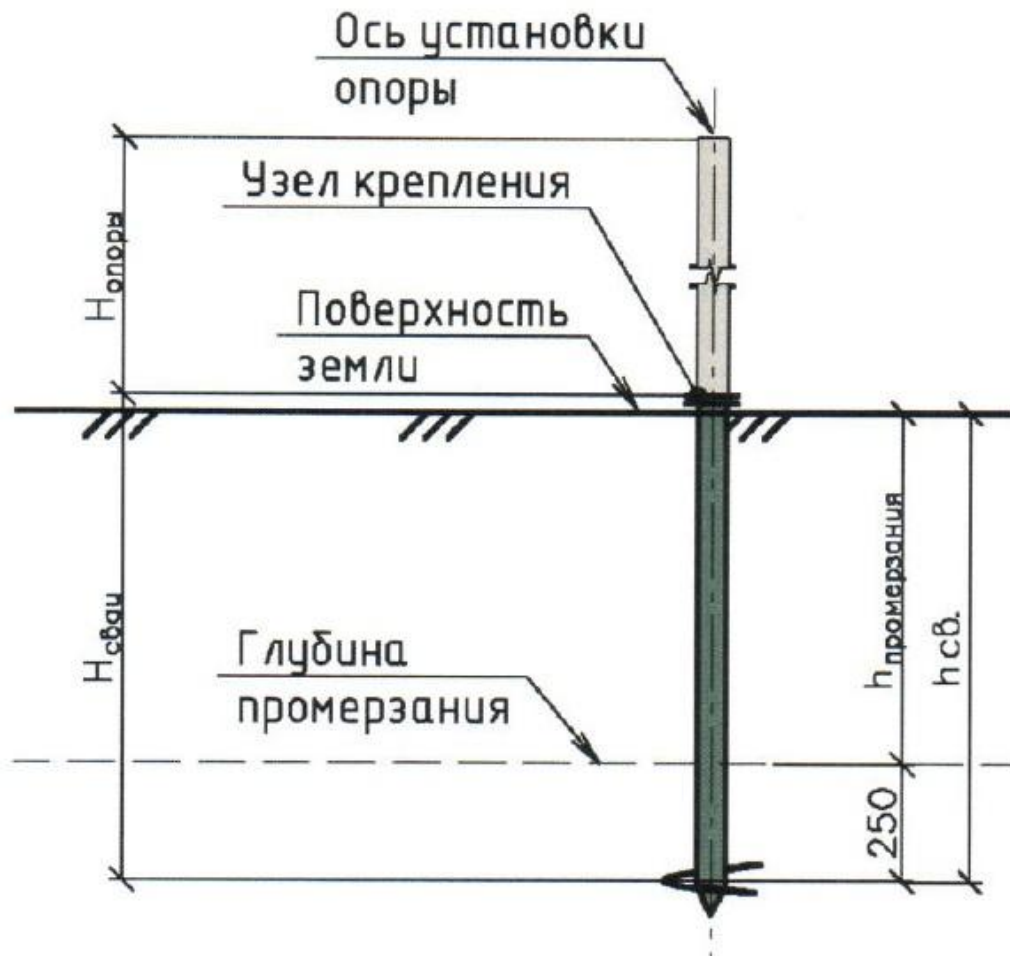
Схема устройства фундамента на винтовой свае
